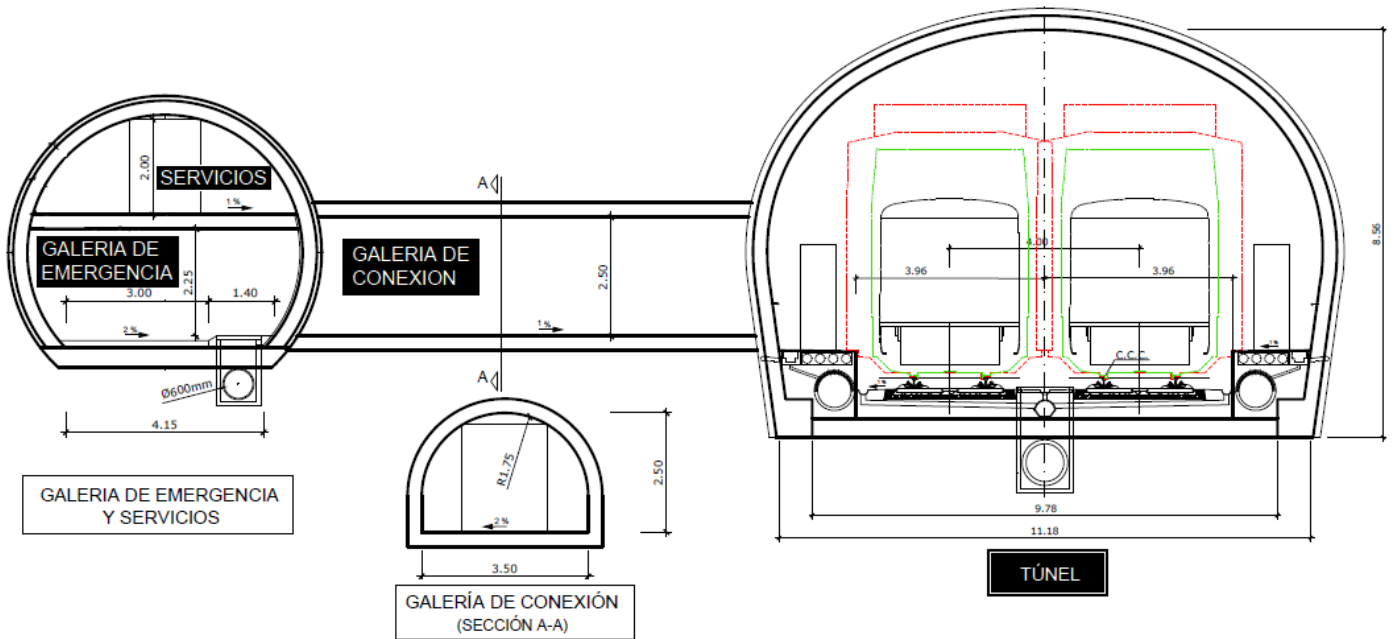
Sección del Túnel, de la Galería de Conexión y de la Galería de Emergencia.
